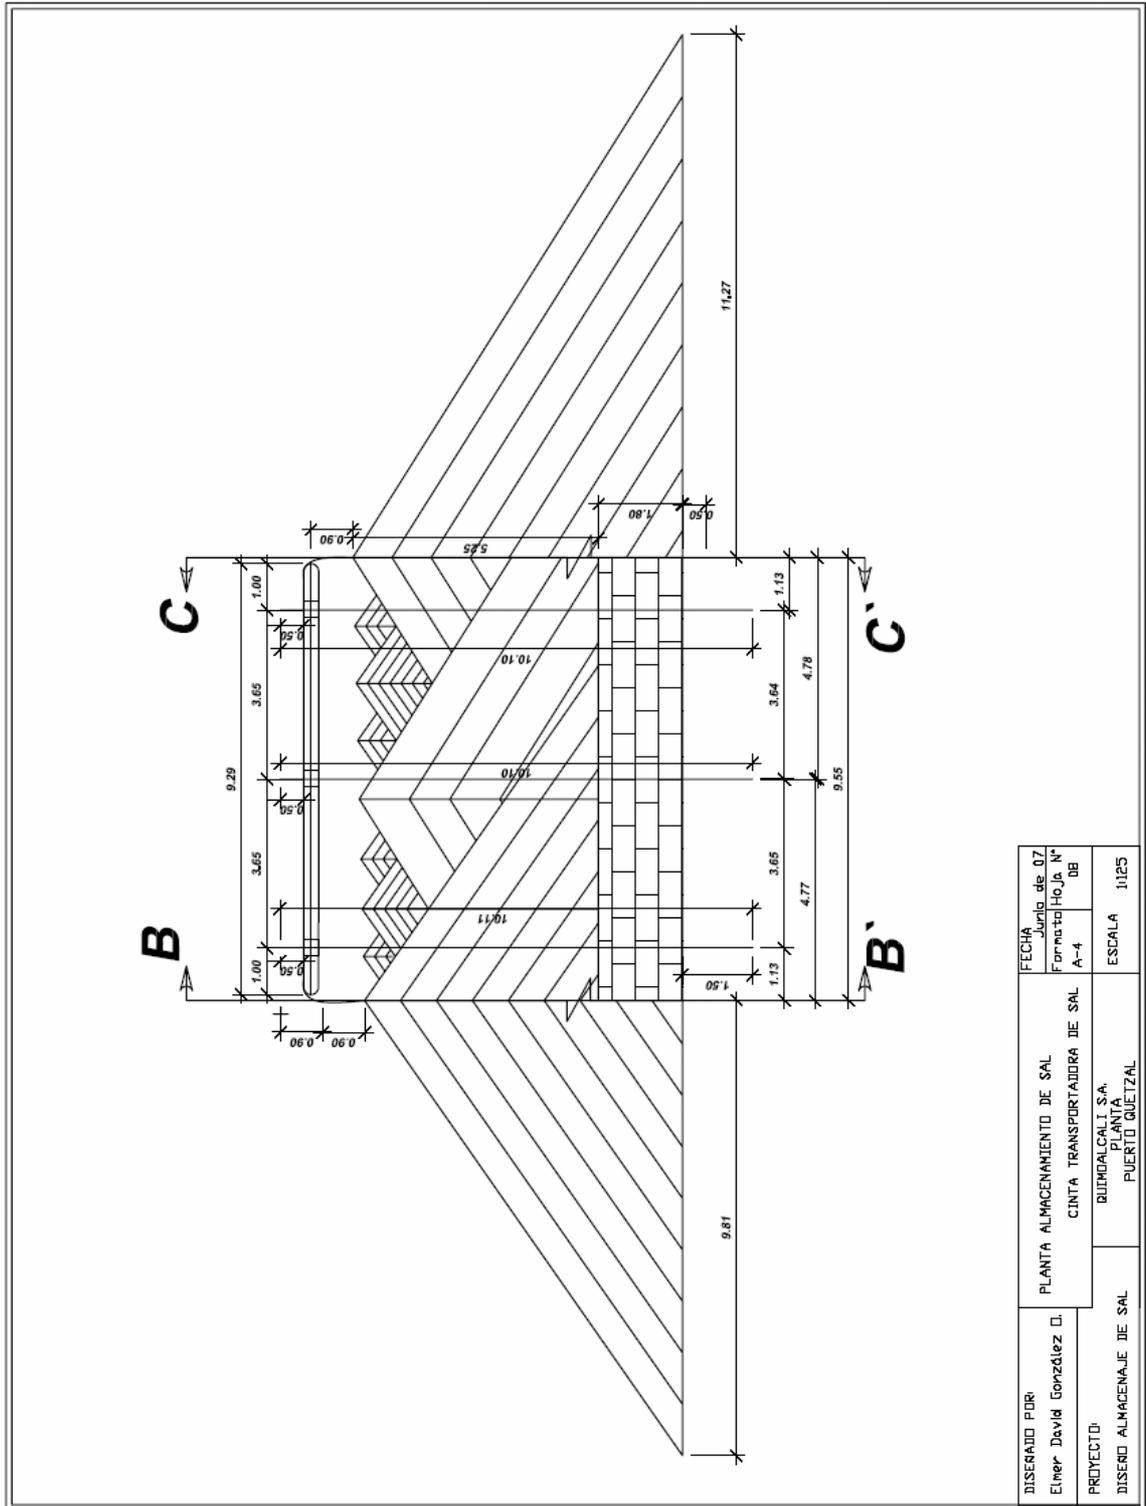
Plano isométrico de la estructura de la cinta 1 con un ángulo de inclinación
